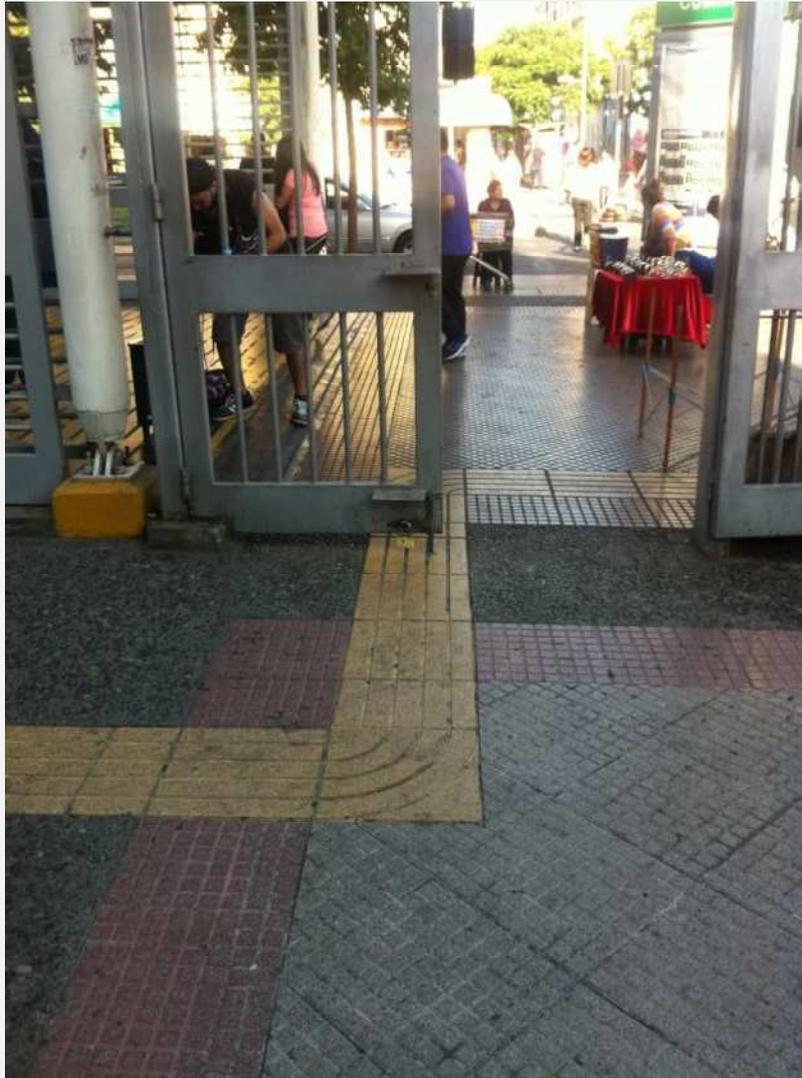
Pavimento Táctil- Estación de Metro La Cisterna.
